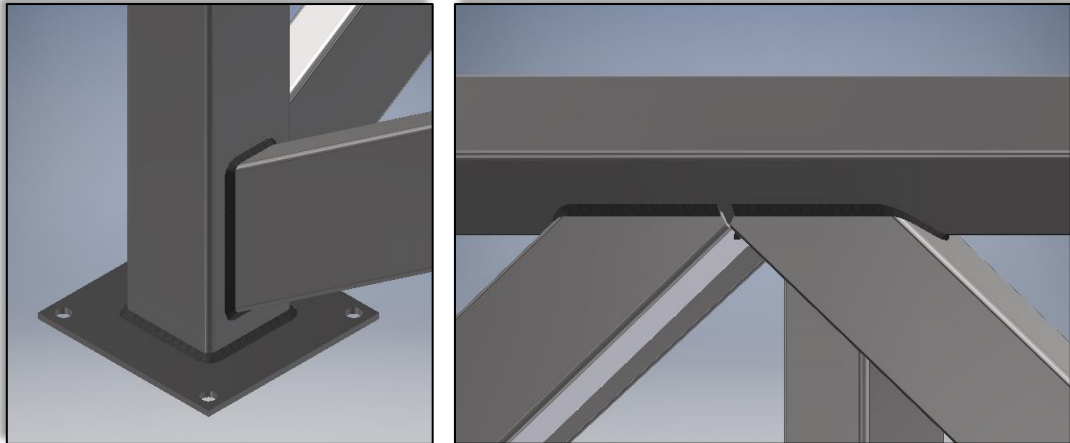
Soldaduras particulares de caños en reticulado
